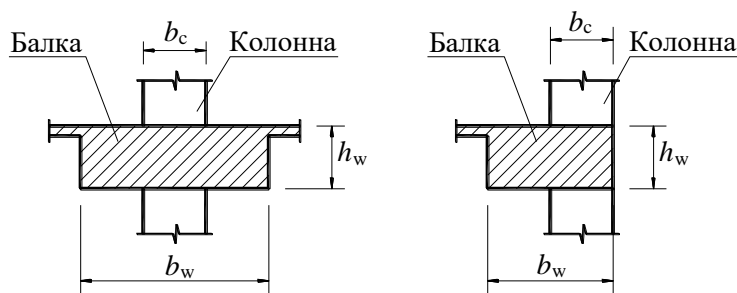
Схемы расположений балок относительно колонн согласно условию (4.2)
